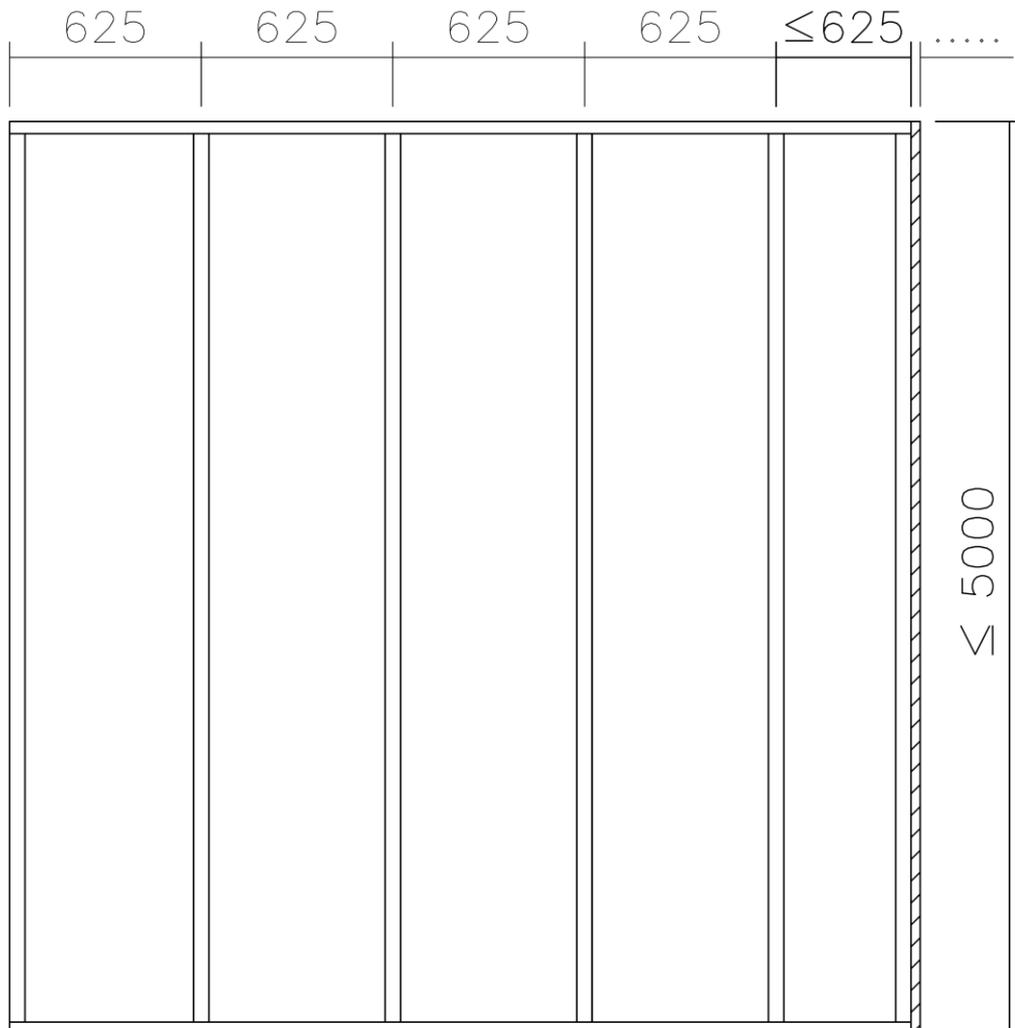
/ 1 *Beispielansicht zur Ausführung der Tragkonstruktion
